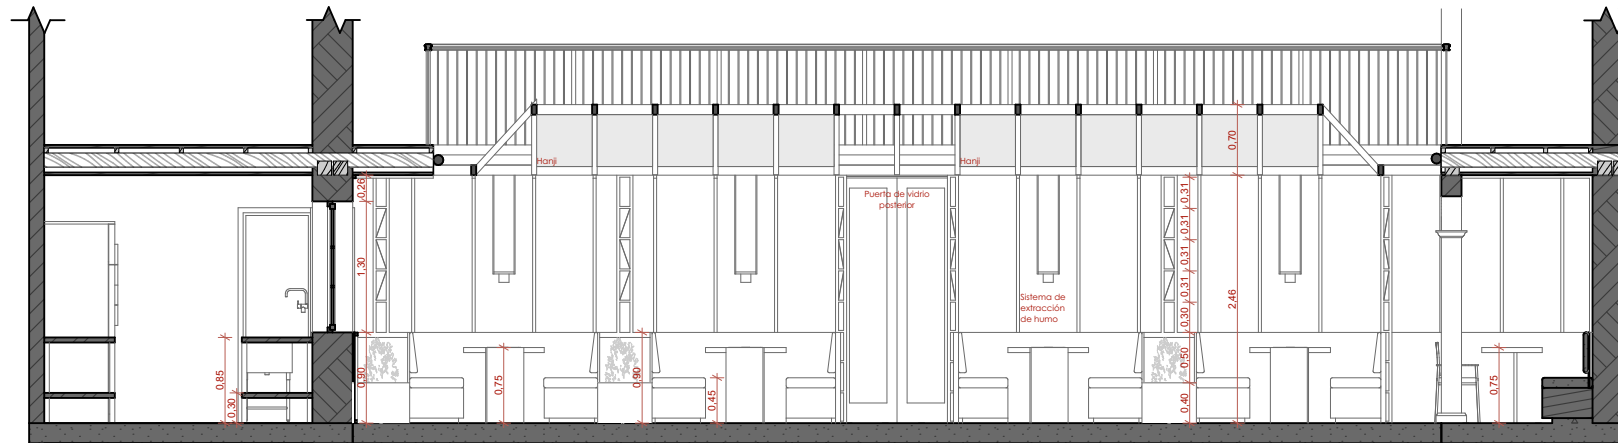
Corte Longitudinal B-B. Fuente: Elaboración Propia
